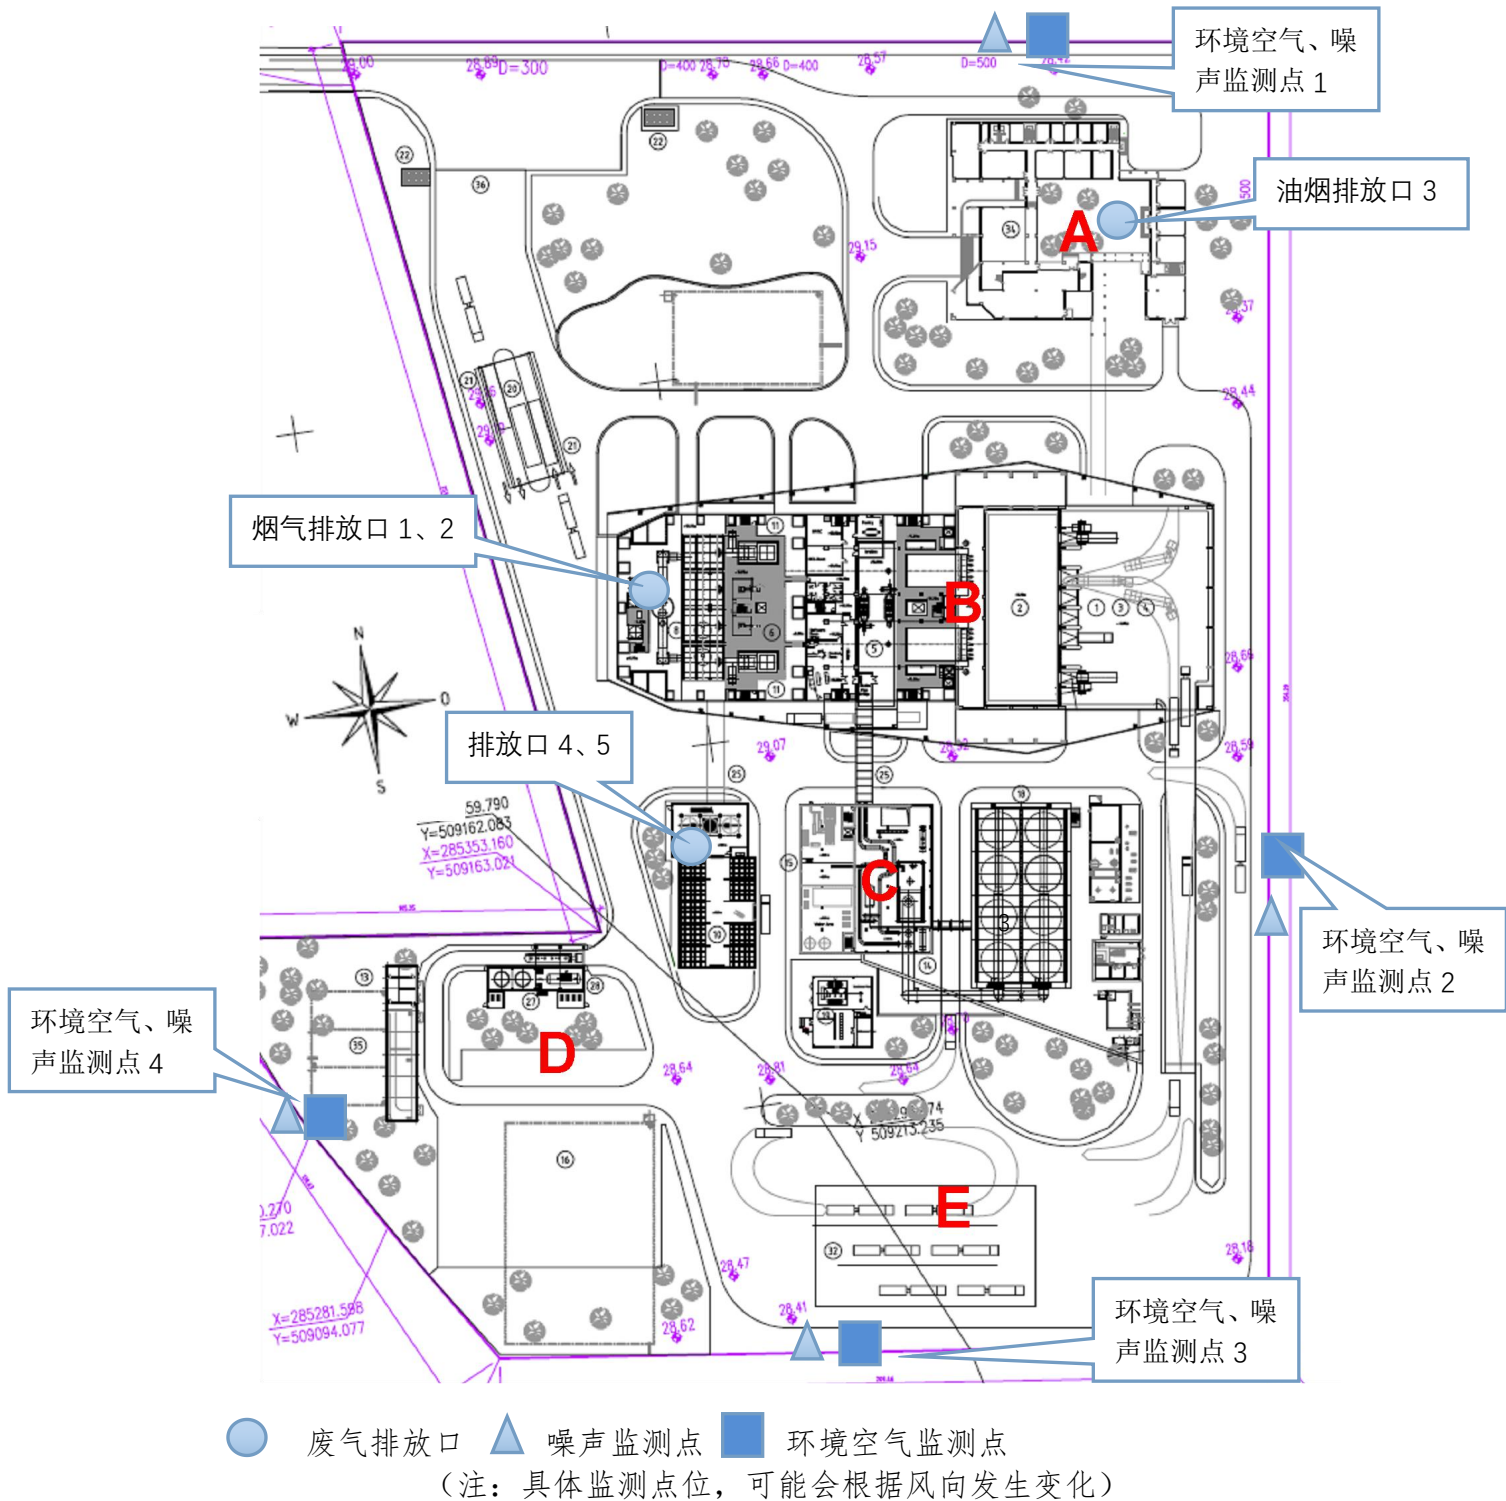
：南宫生活垃圾焚烧厂厂区平面图及监测点位置图
